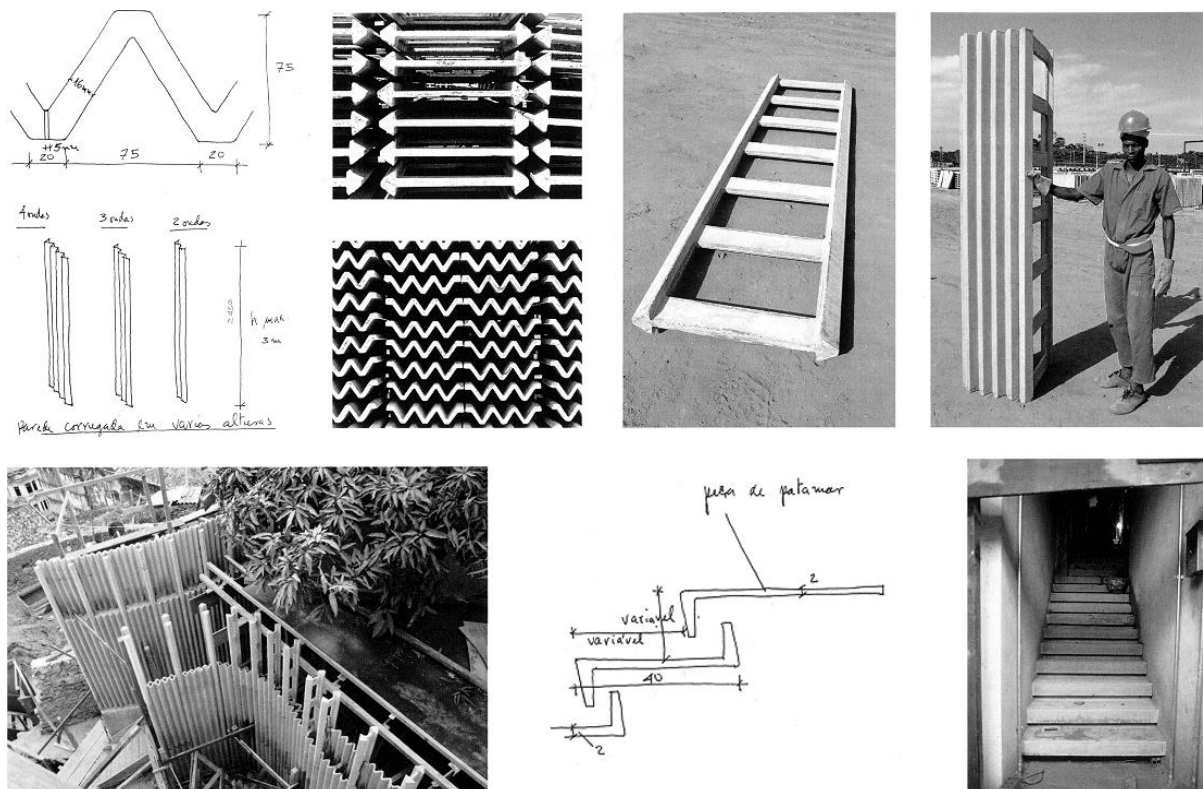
Contrafortes, paredes plissadas e escadarias de argamassa armada (desenhos de Lelé)
